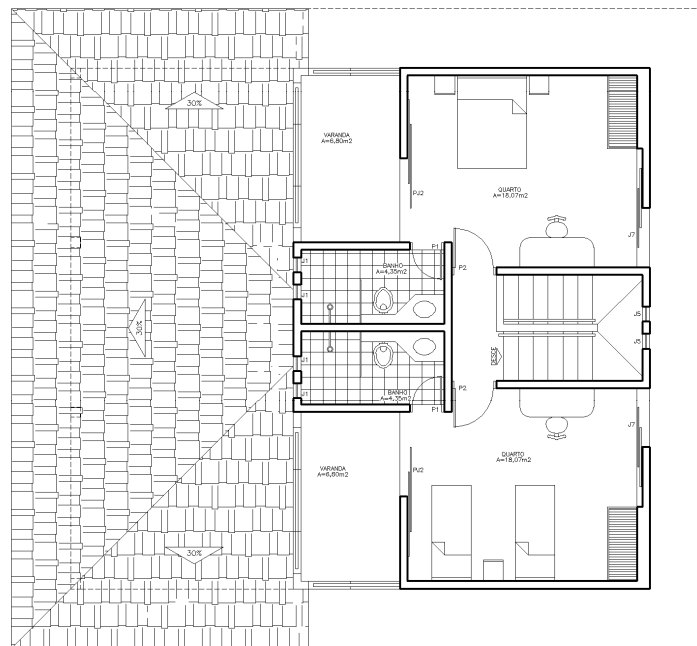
Projeto 3 – Plantas, Cortes e Fachada
